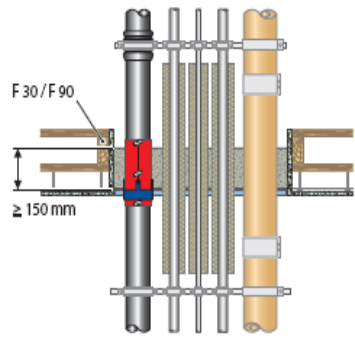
Deckenverschluss-System FSH90 in einer Decke im Holzbau
